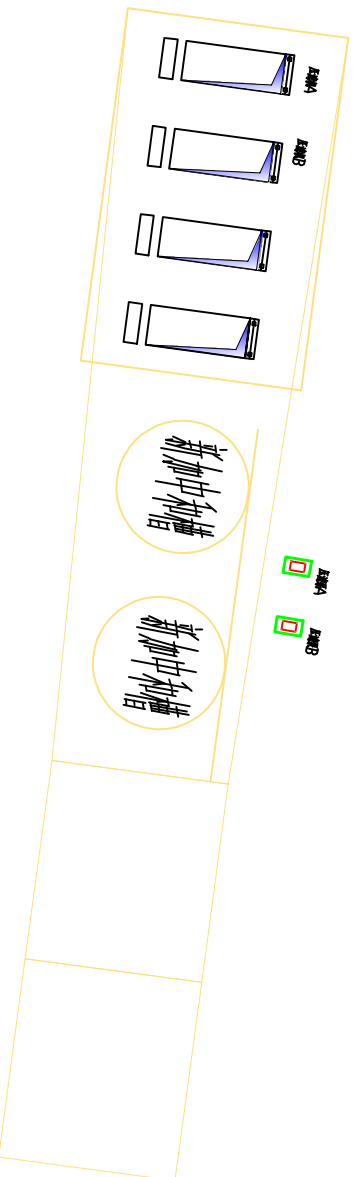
(4) 无水氯化钙中和压滤装置区平面布置图
